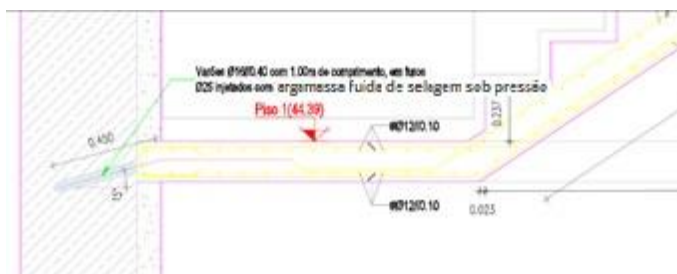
Varões de ligação entre a parede de alvenaria de pedra e a laje
